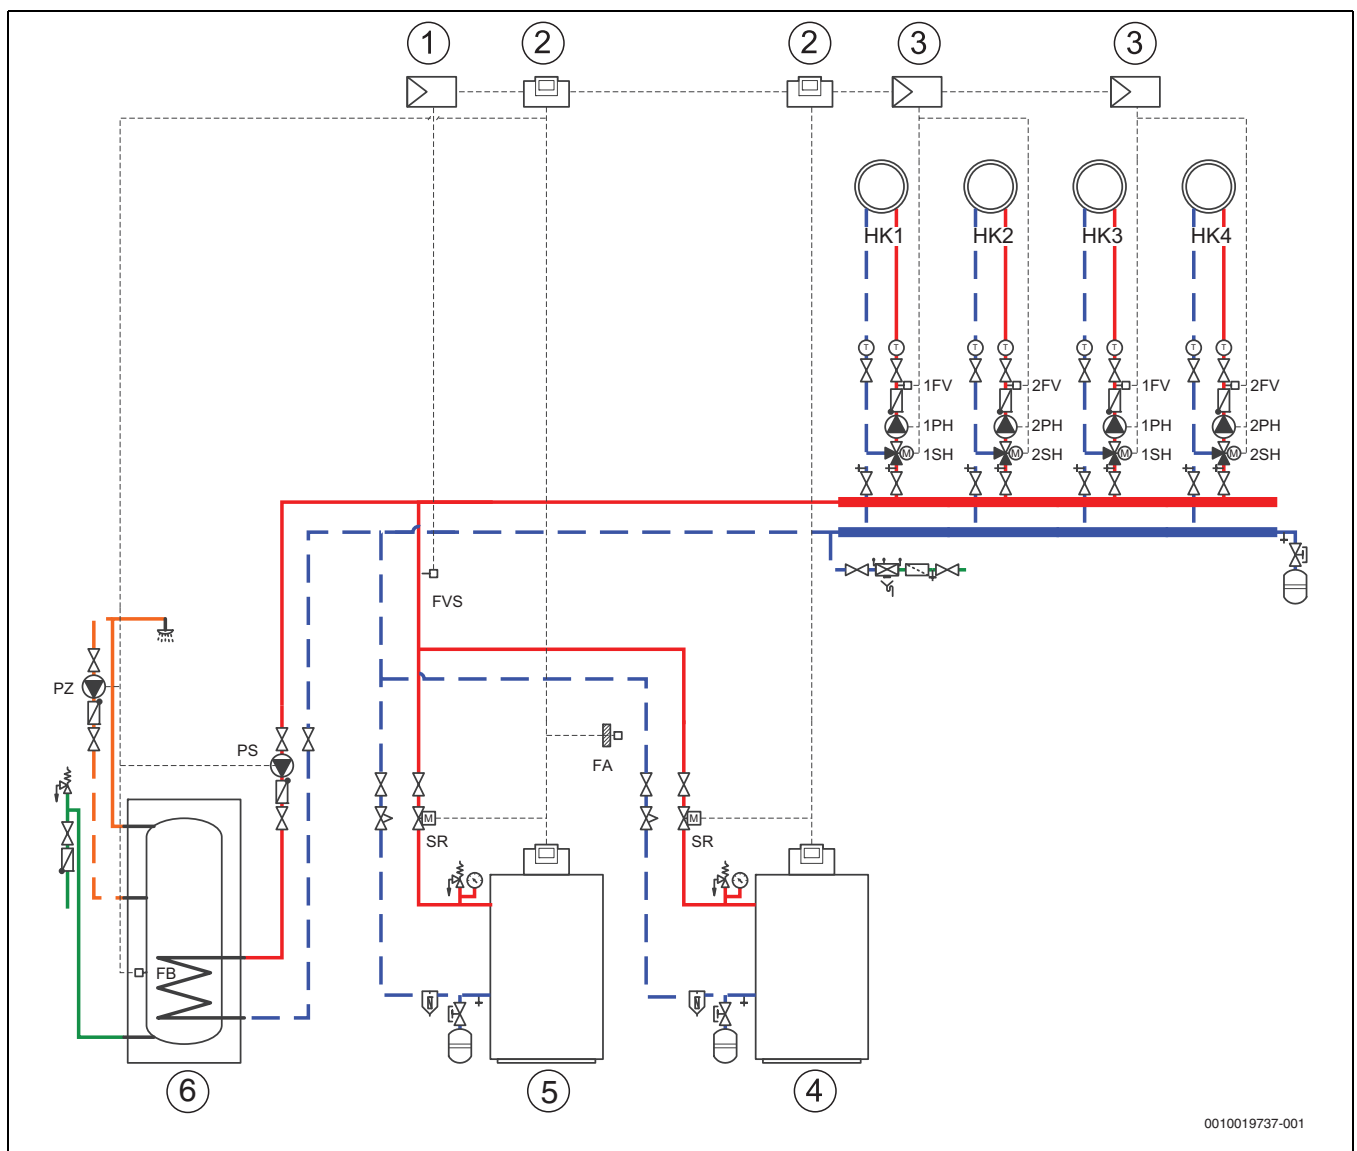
Hydraulik 1: Wärmeerzeuger mit Feuerungsautomat SAFe in Parallelschaltung
